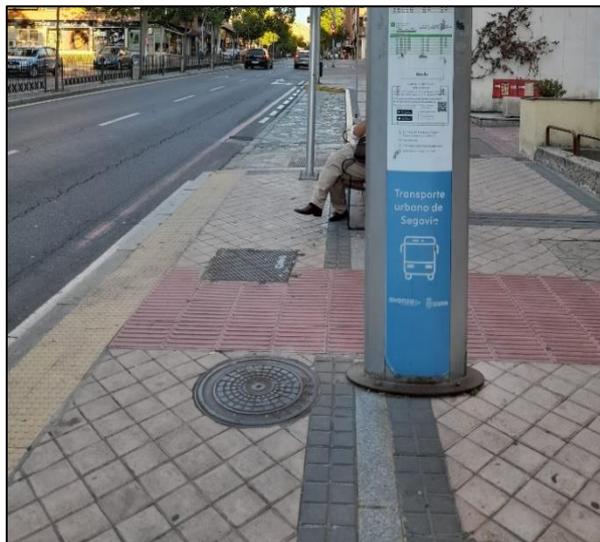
y 5.63: Pavimiento con color contrastado rojo en las paradas de autobús en Segovia
